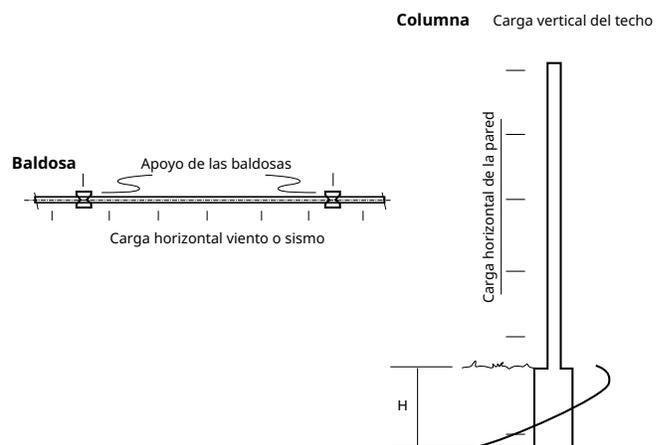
Esquema de cargas y reacciones del Sistema Prefa Holcim: (a) Vista en planta (b) Elevación del sistema principal sismo como de viento
